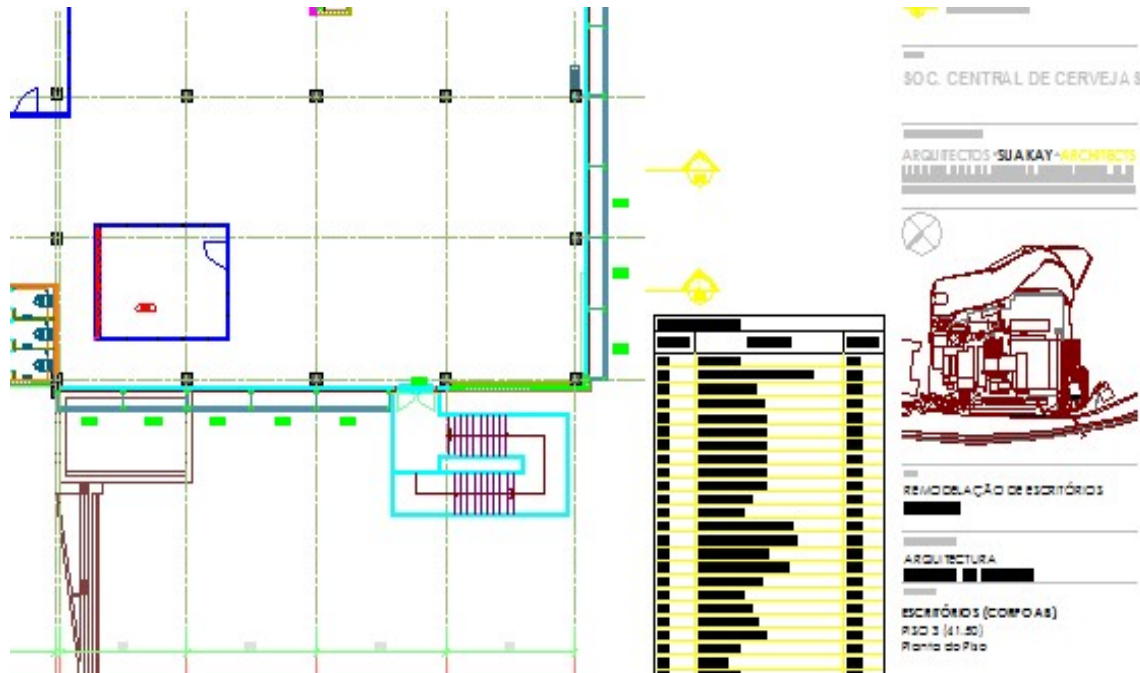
POSIÇÃO FINAL DA ESCADA METÁLICA
